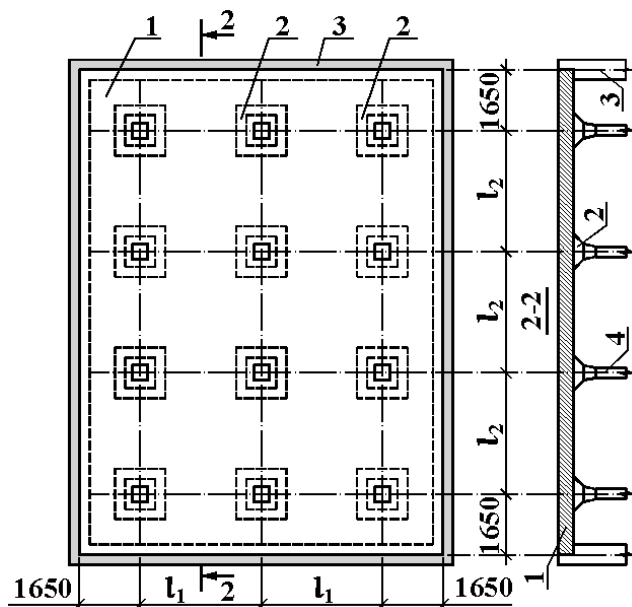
План монолітного безбалкового перекриття з капітелями:
